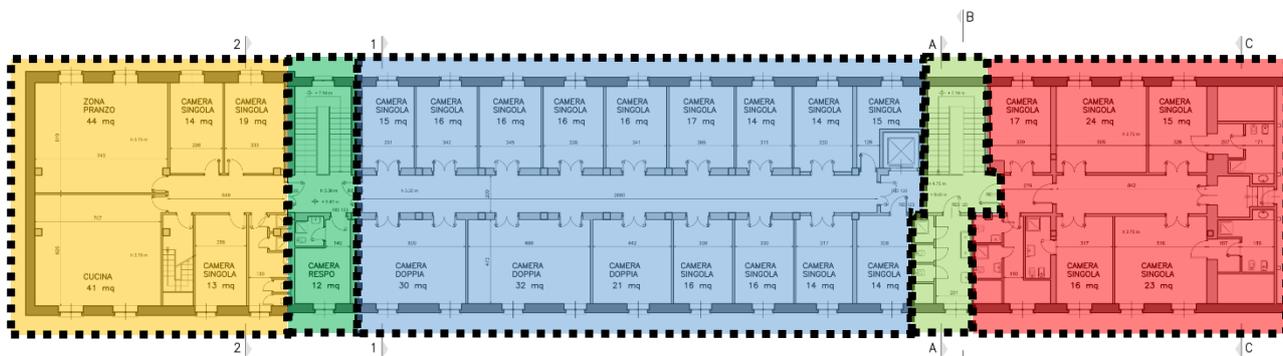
Schema distributivo piano delle camere – stato di fatto
